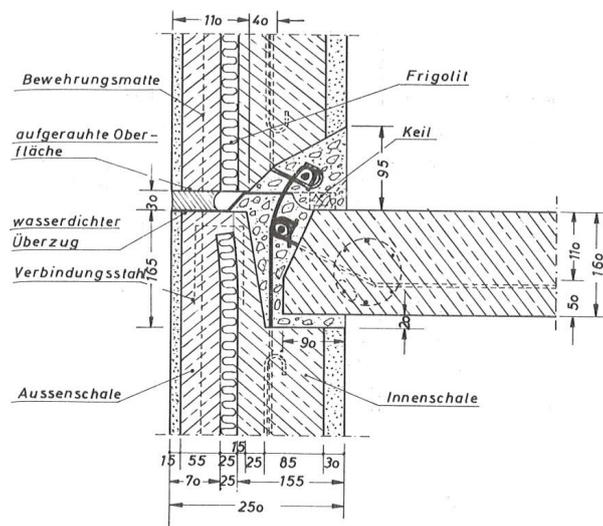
Deckenaufleger Außenwandtyp: Typ Lorraine No.2 1956, nach HALÁSZ und TANTOW (1964) [28]
